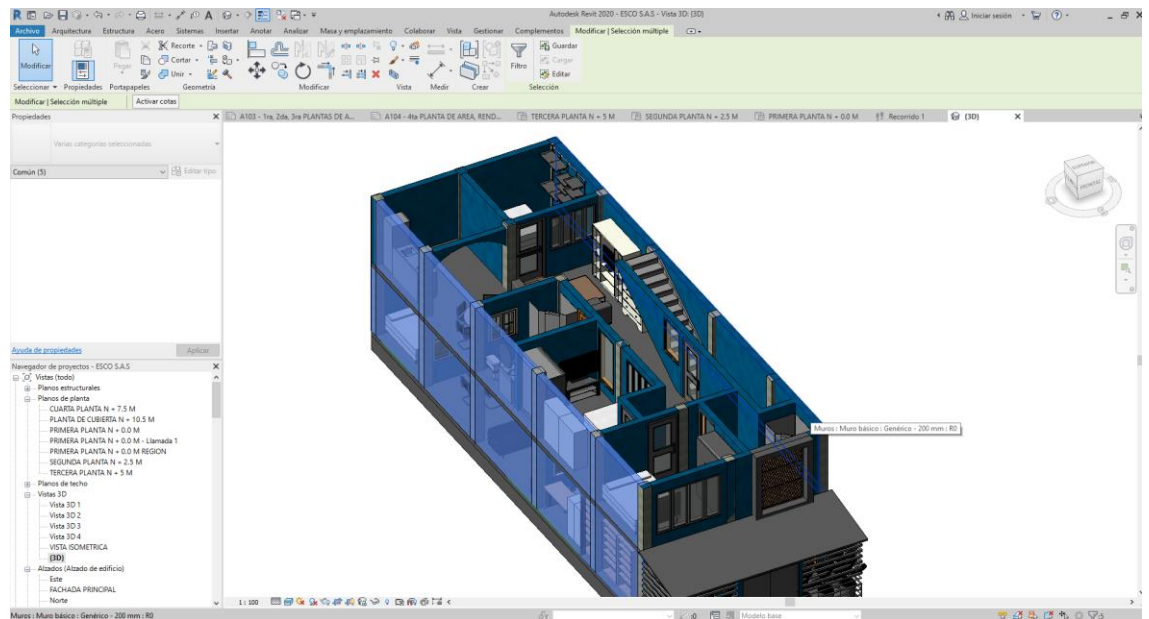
Corte de la segunda planta. Revit. Fuente elaboración propia.
